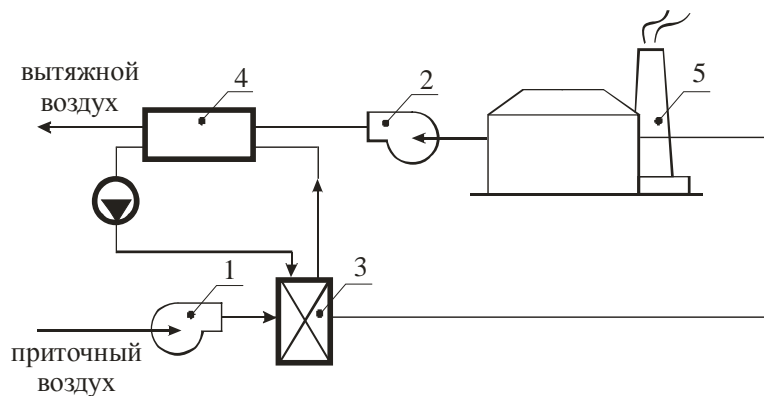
Применение теплового насоса для подогрева приточного воздуха в системе вентиляции.
